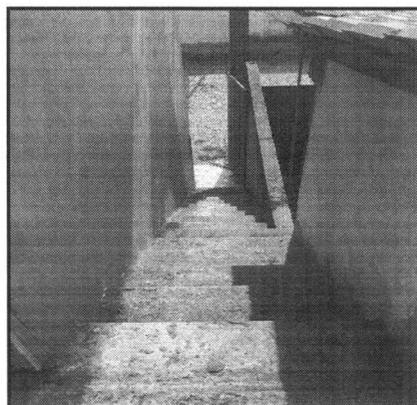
Imagem de escada de acesso ao pavimento superior, sem guarda corpo
